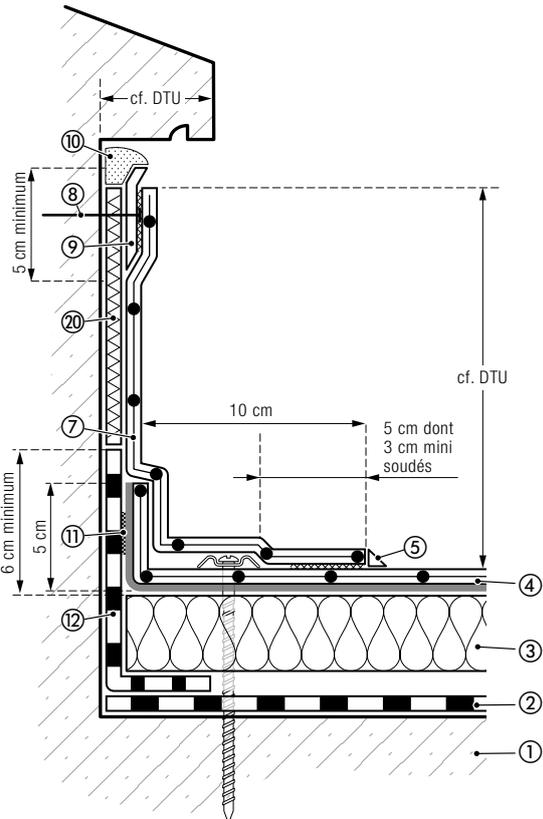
Relevé d'étanchéité de hauteur ≥ 200 mm avec fixation intermédiaire et avec pare-vapeur bitumineux sur maçonnerie
